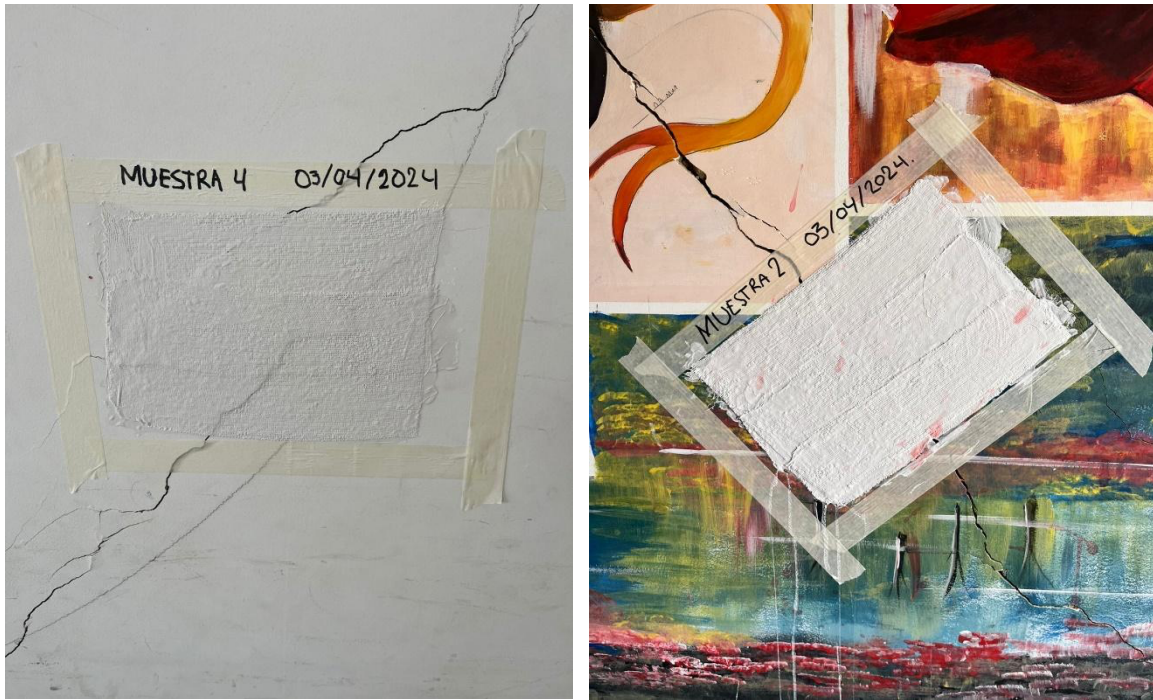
Instalación de testigos para control de fisuras fuente propia, en muro de acceso y en muro de sala de juntas.
